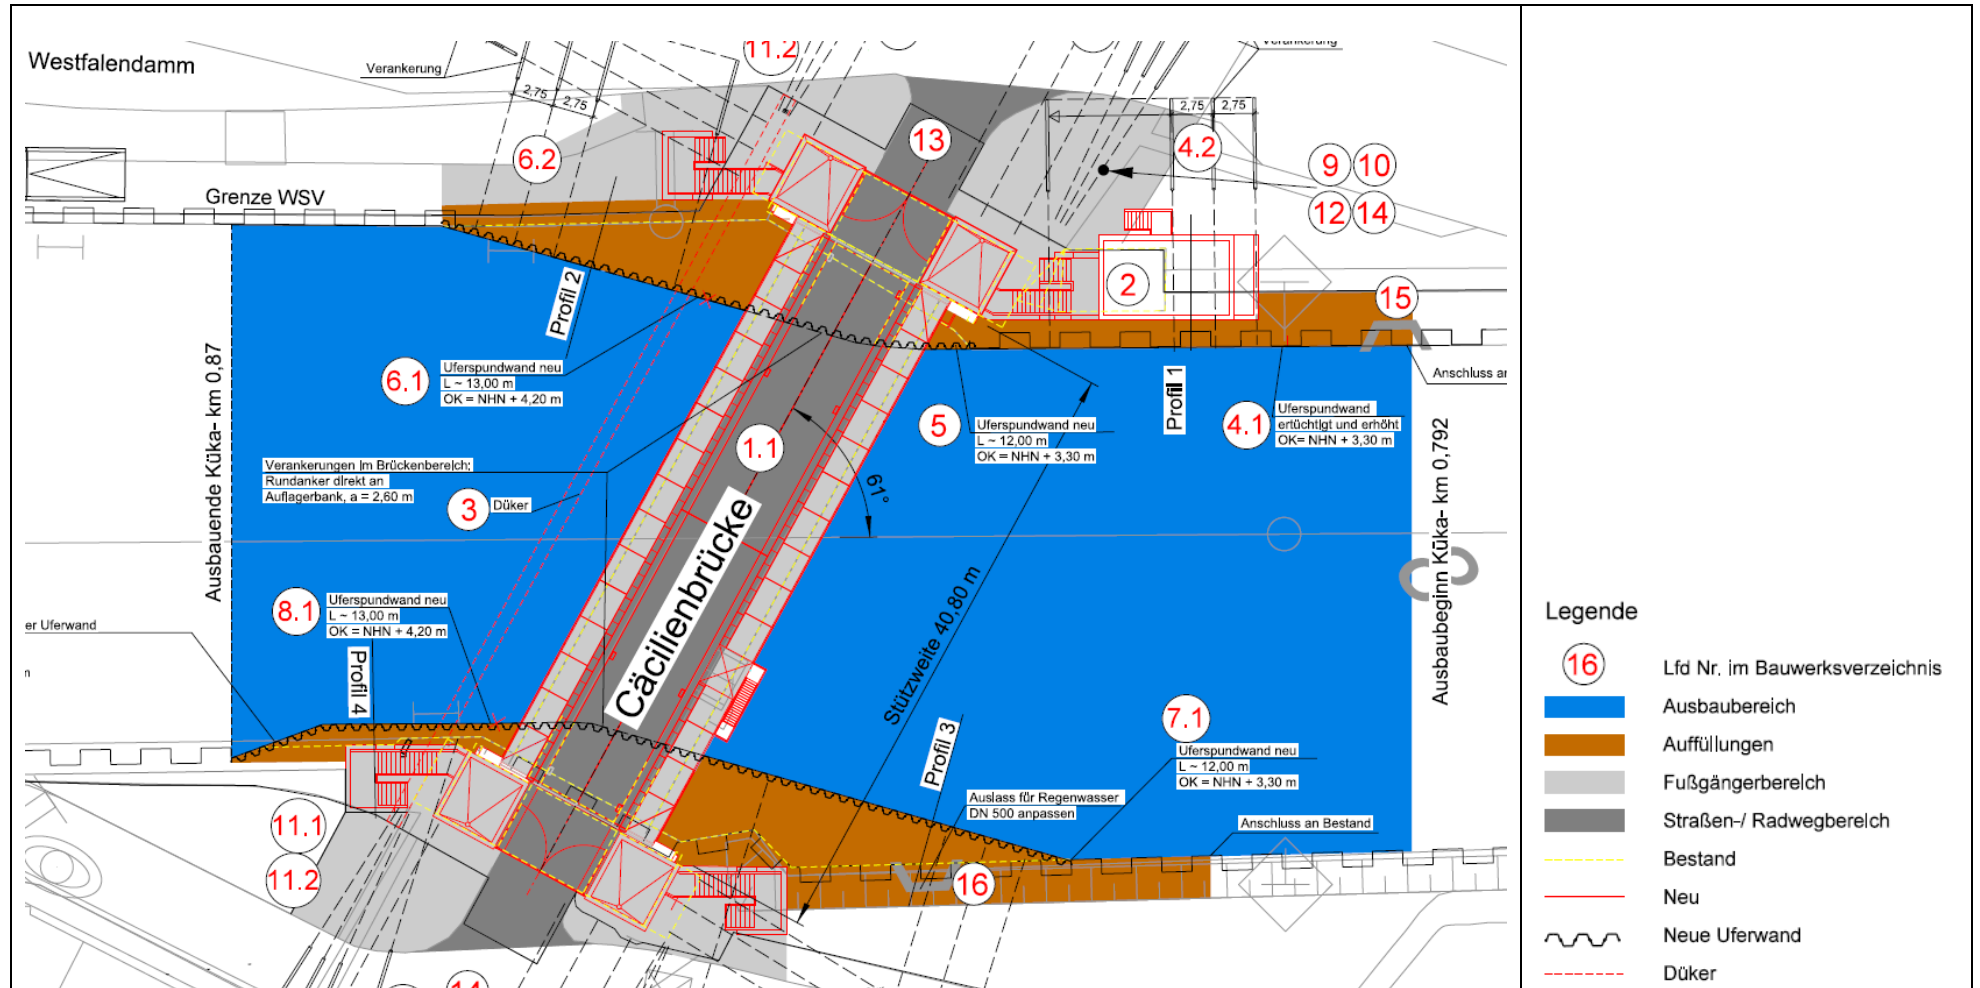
Bauwerks-Lageplan zum Ersatzneubau der Cäcilienbrücke (Quelle: WSA WJN, 2021)
